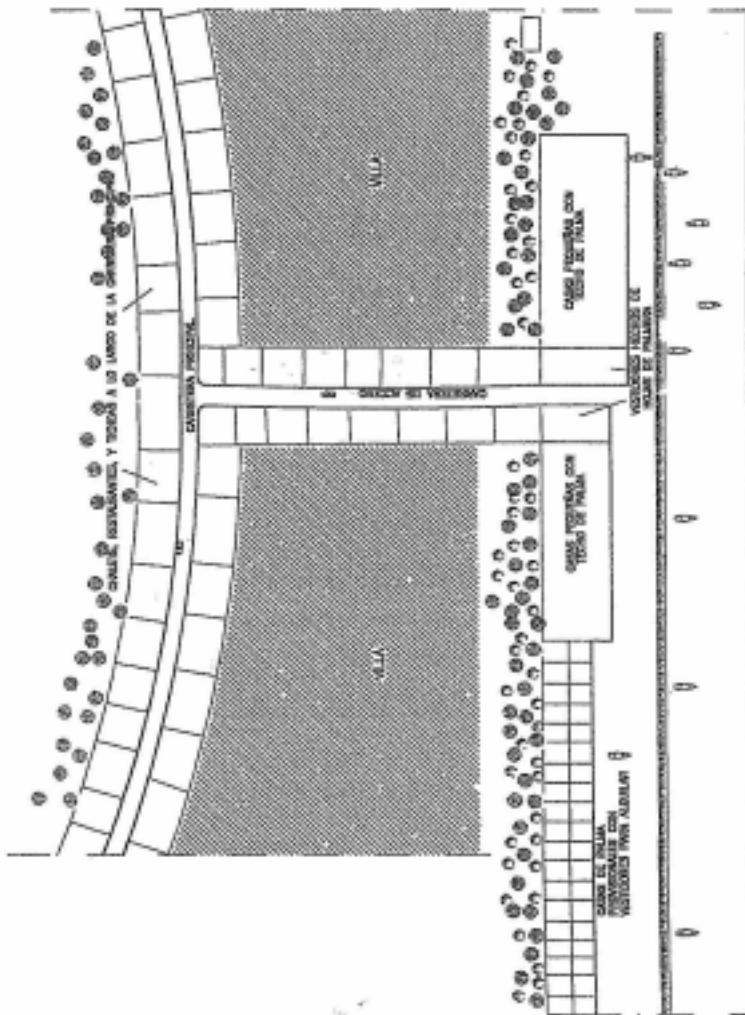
サン・アントニオ・ロス・ブランコス漁村の概略平面図
